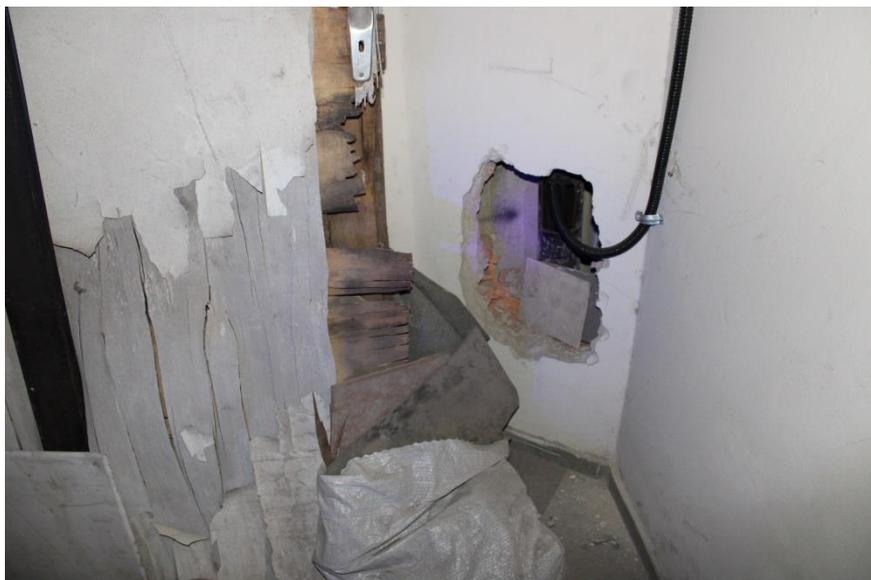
Vista entulhos na caixa de escada de acesso à casa de máquinas
